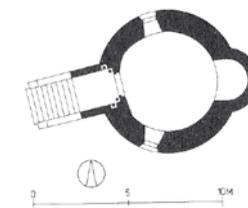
Grundriss Dehio NÖ 1990, 619. M 1:400.
